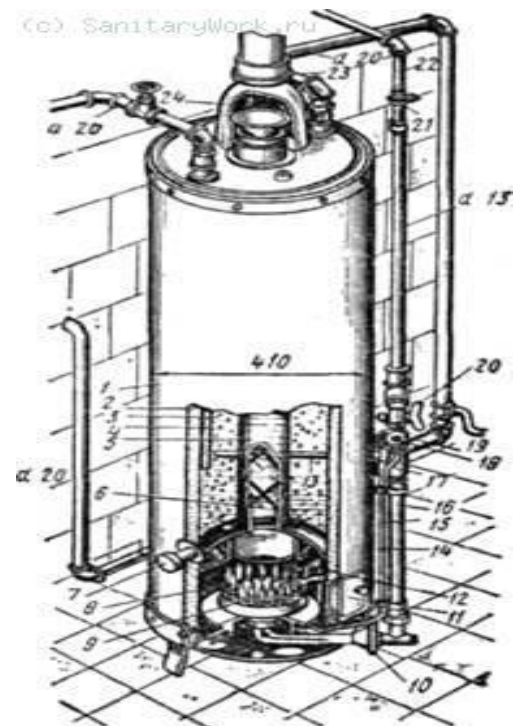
Схема автоматического газового водонагревателя АГВ-80
